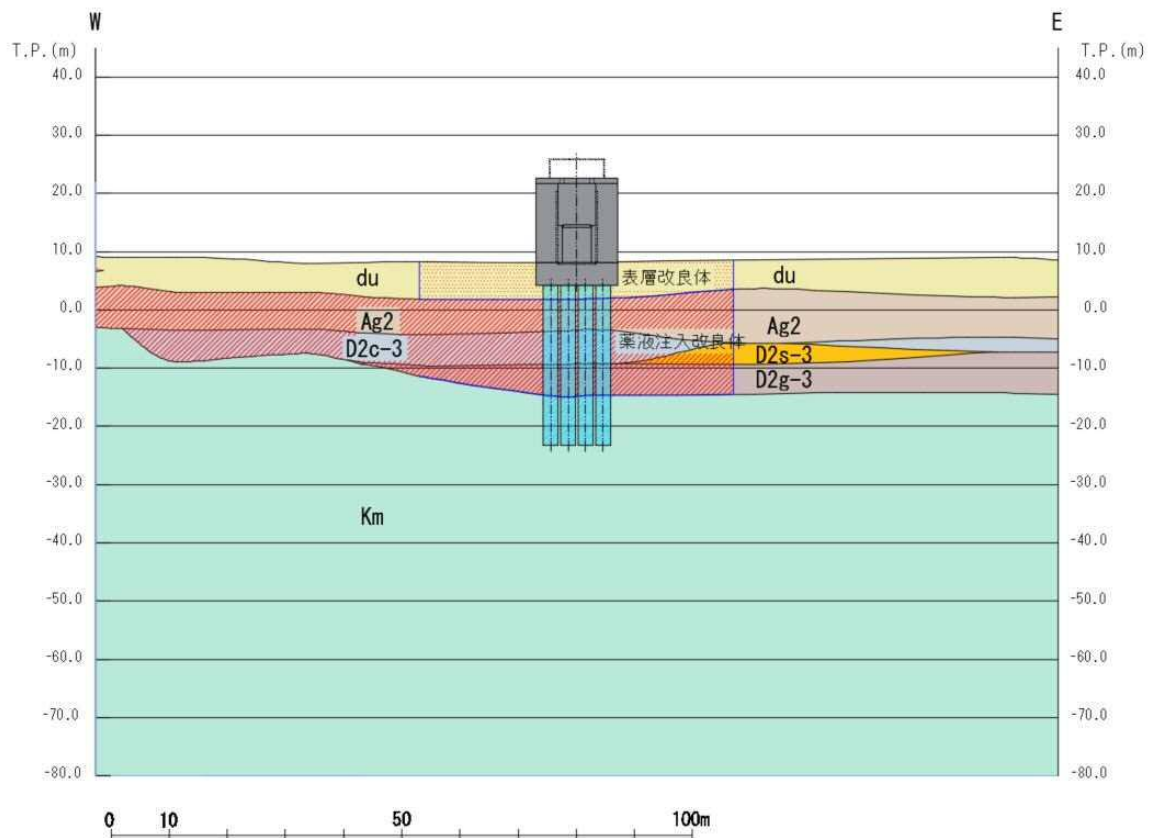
(2) 評価対象断面図 (B-B断面)
